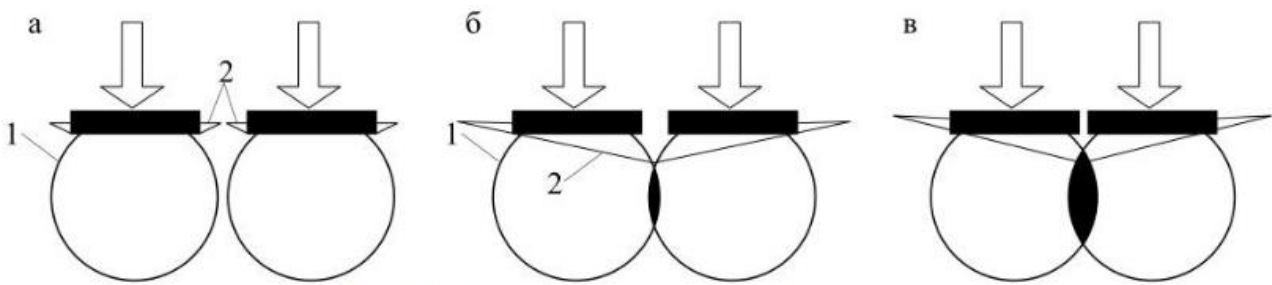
Взаємний вплив двох фундаментів: а) зони напружень не перекриваються; б,в) зони напружень перекриваються; 1) зона напружень; 2) вирва осідання.
